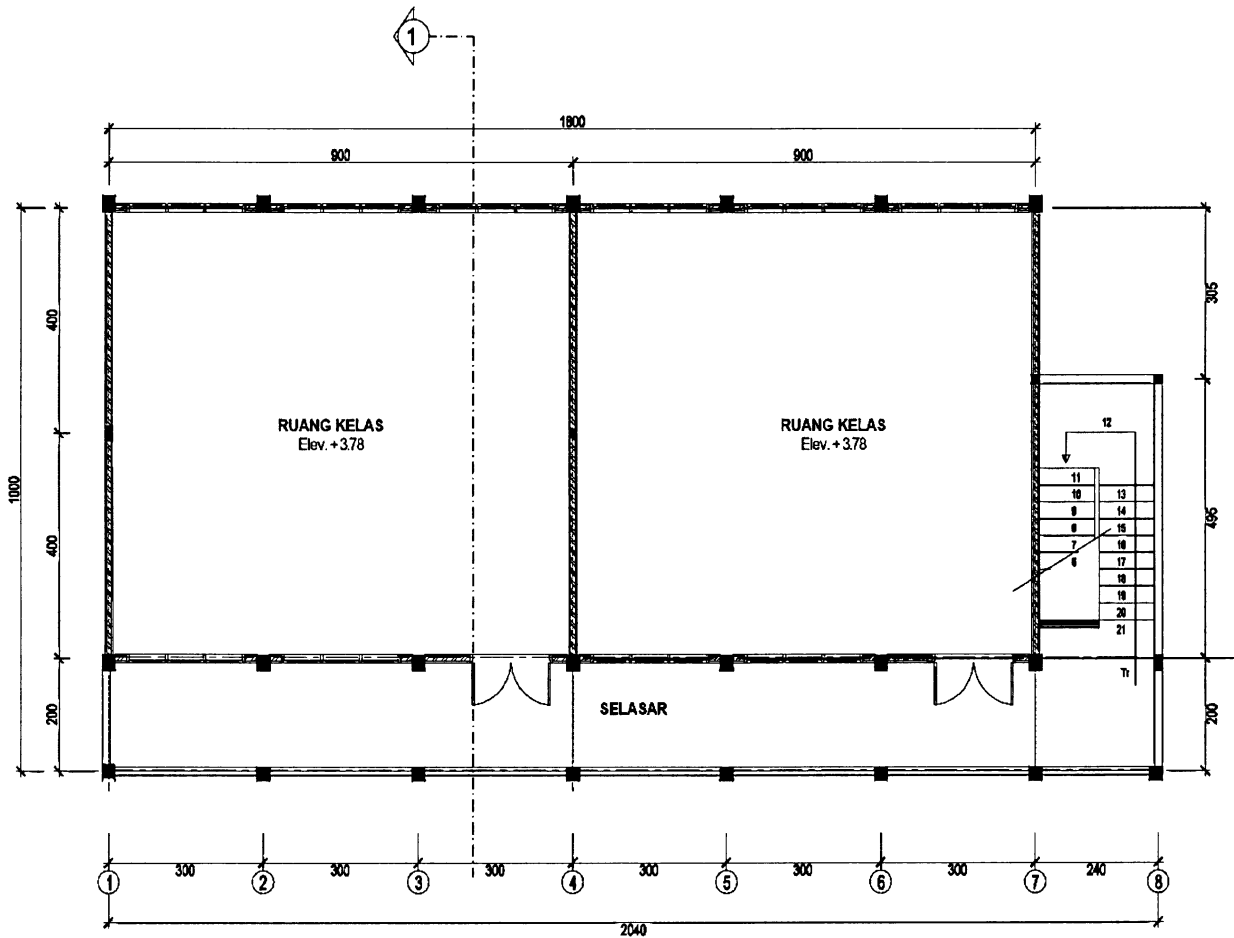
Denah Lantai Satu Ruang Kelas Bertingkat
